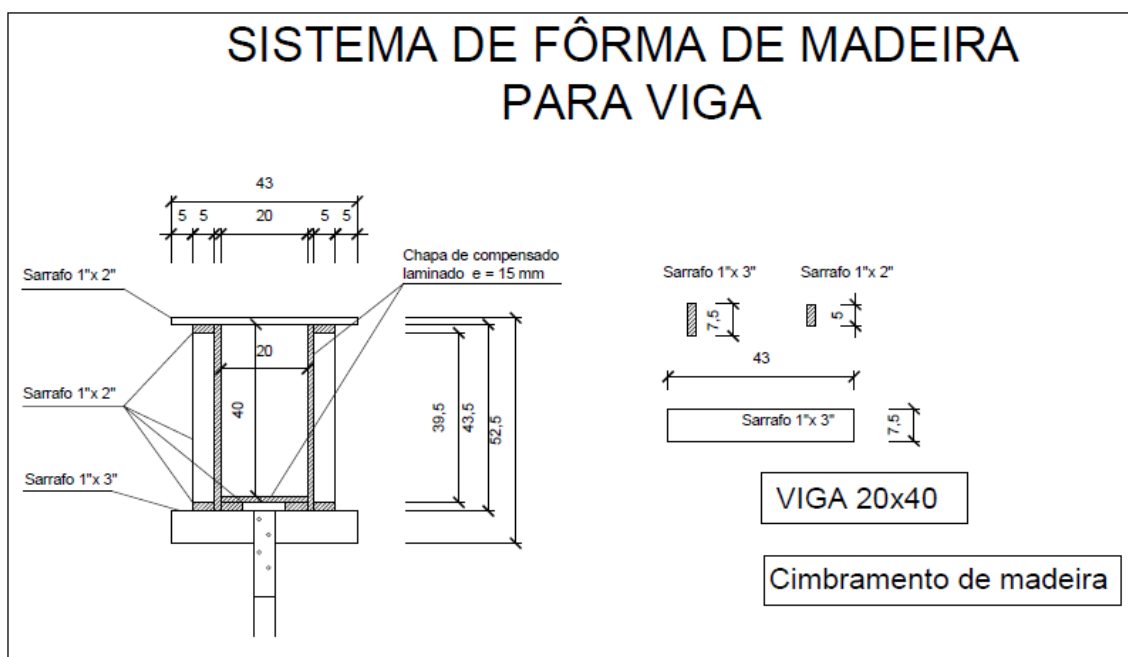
Modelo 01 de fôrma para viga de concreto armado.
